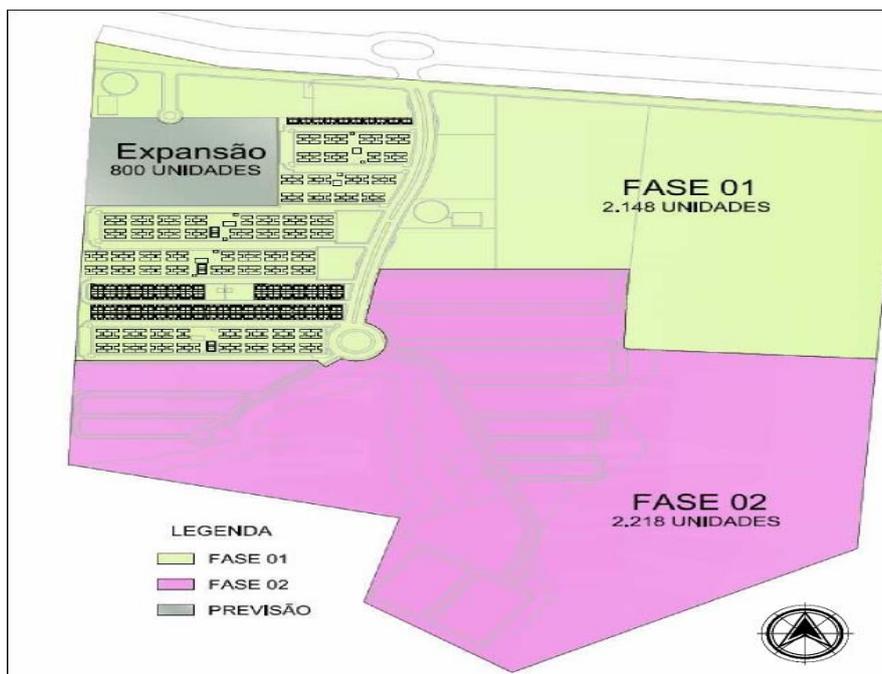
Implantação geral do Conjunto Macapaba – fases de execução do projeto. Fonte: SEINF/COOHA, 2012, elaborado pelos autores, 2014.
